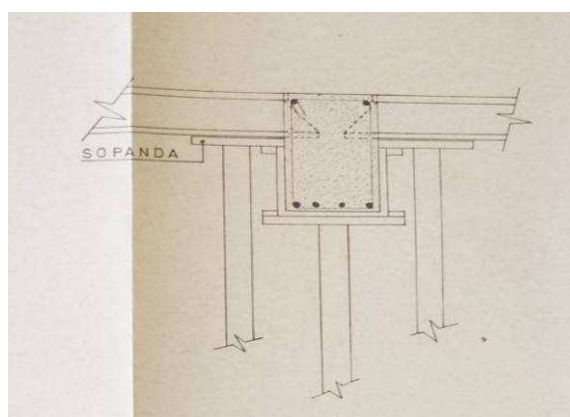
Detalle constructivo de ejecución de vigas. Edificio ficha 212C.009, 1971.
